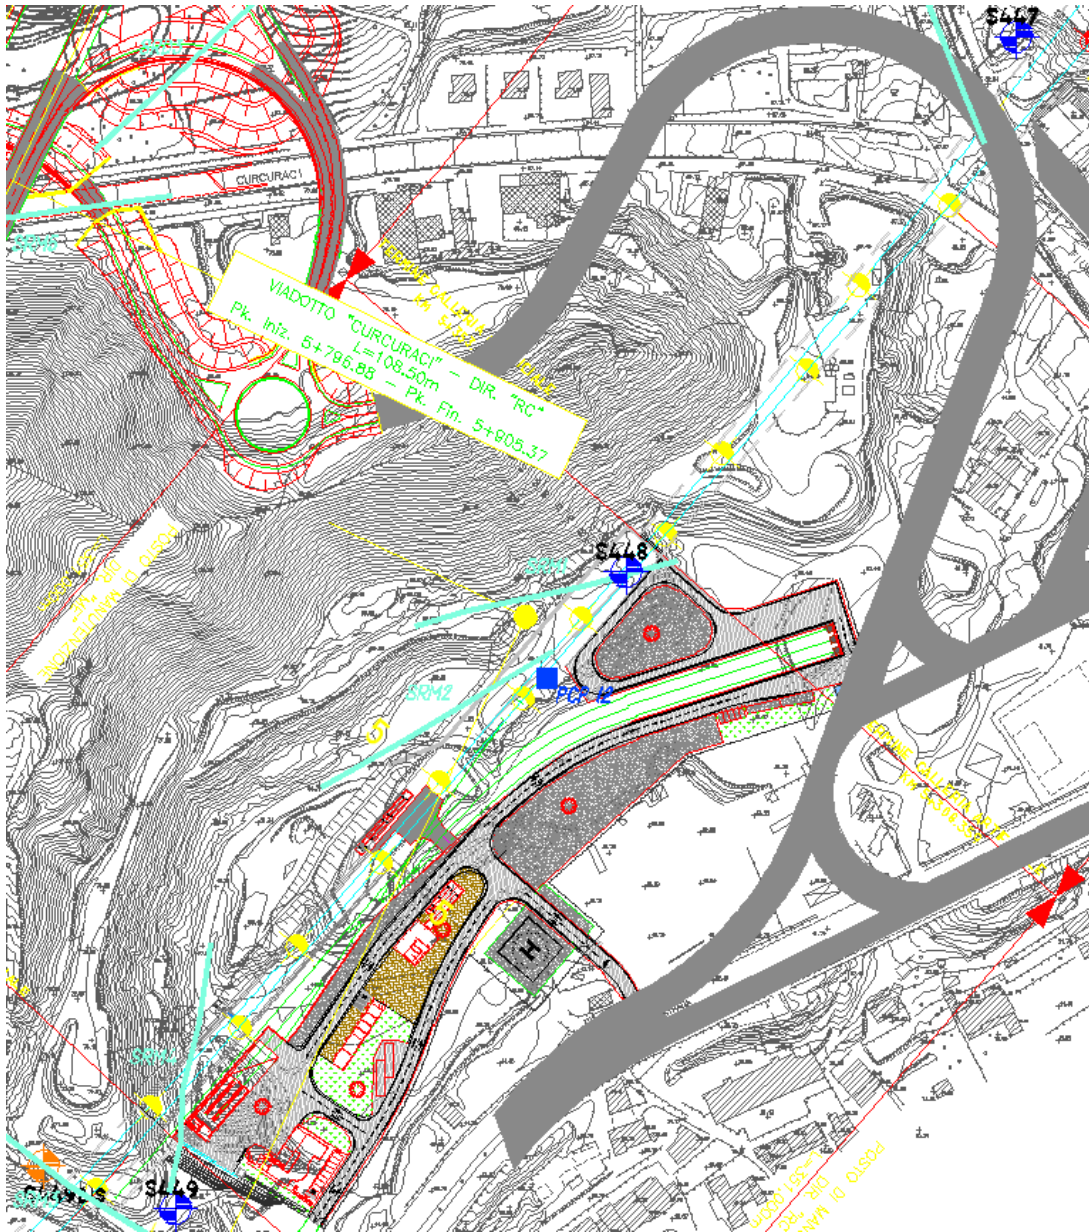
stralcio planimetrico del posizionamento dei sondaggi
